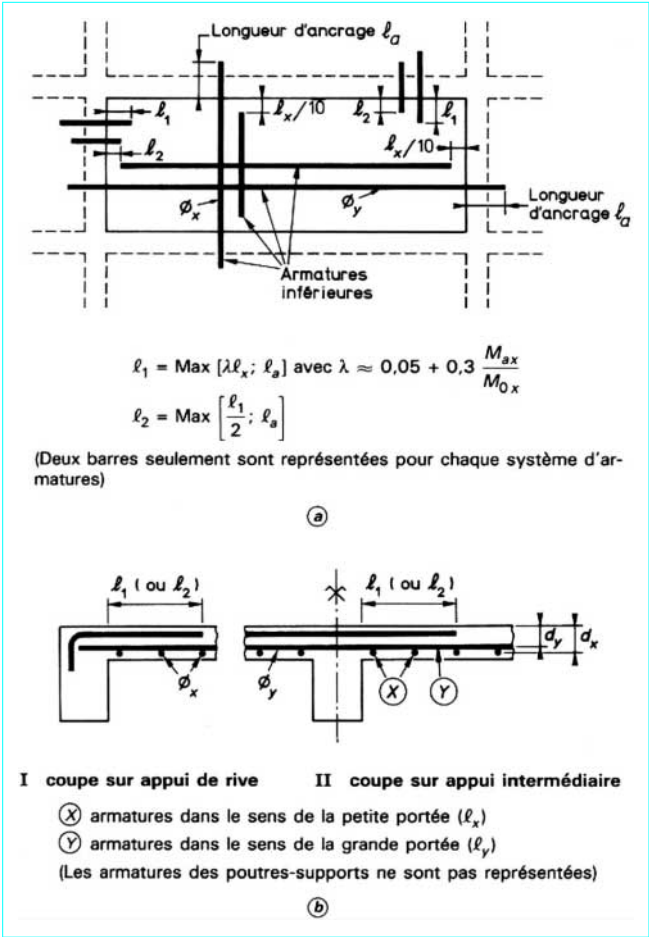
Disposition des armatures dans une dalle bordée de poutres
